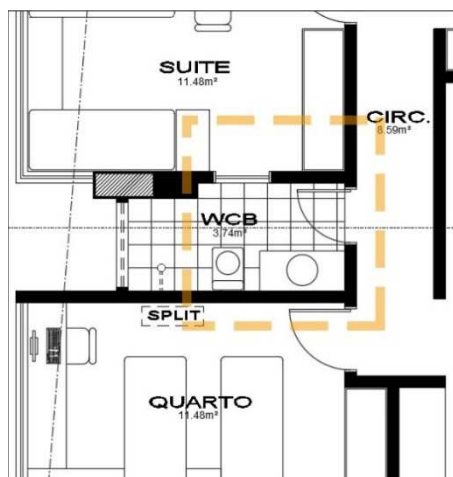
Planta baixa da suíte reversível na terminação 02 do Ed. Acqua
